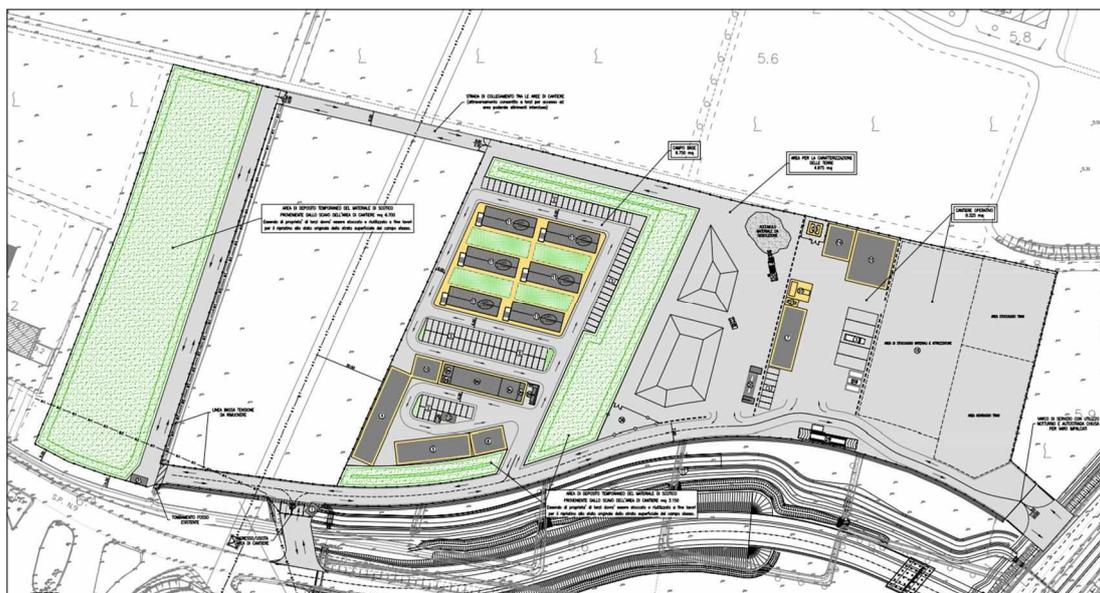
Layout dell'area di cantiere CB01 (agg a PE da SIC5300)
